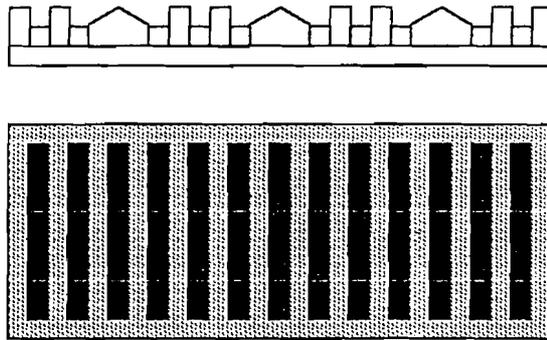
Ornament Pada Bangunan H. Garuda
